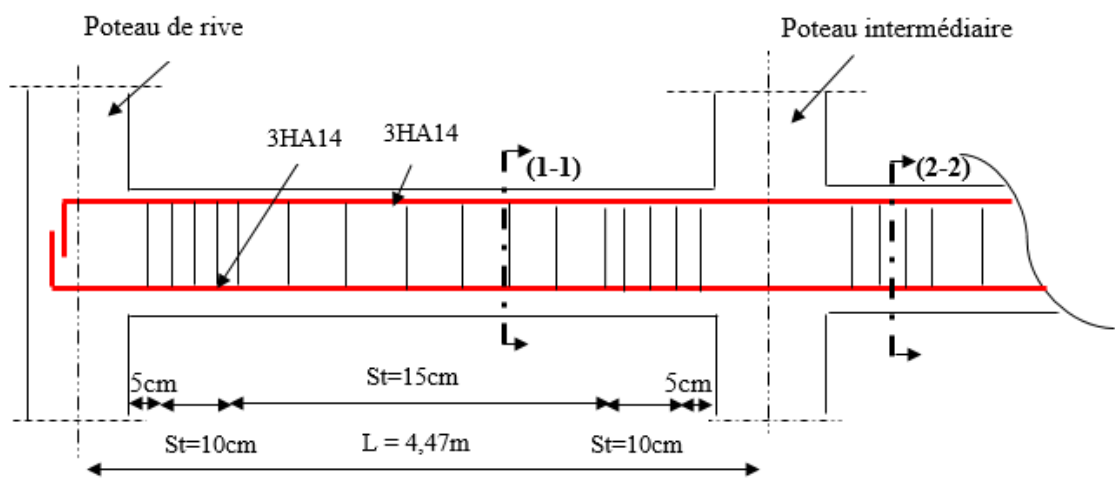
Schéma de ferrailage de la poutre principale du RDC
